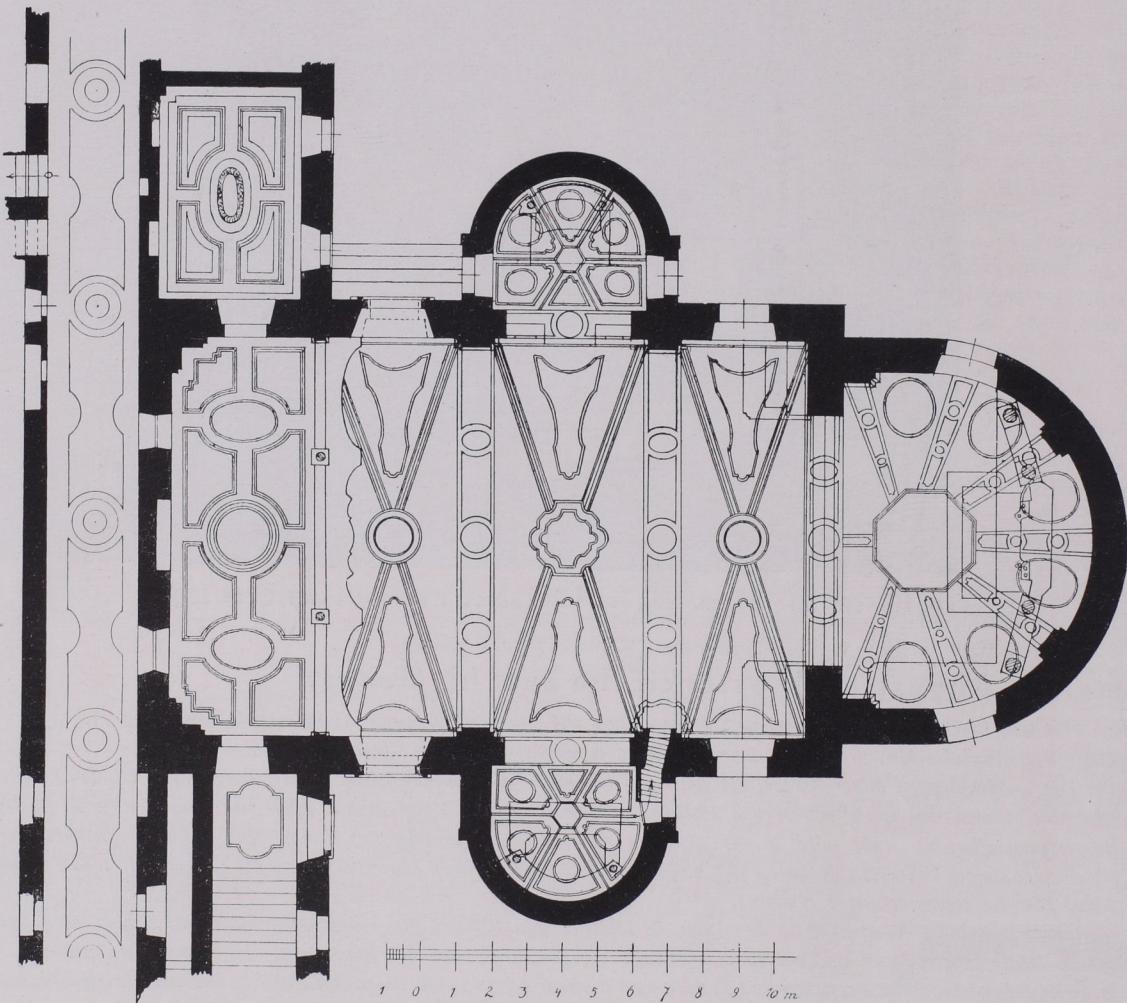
Hallein, Klosterkirche, Grundriß 1:200 (S. 123).
